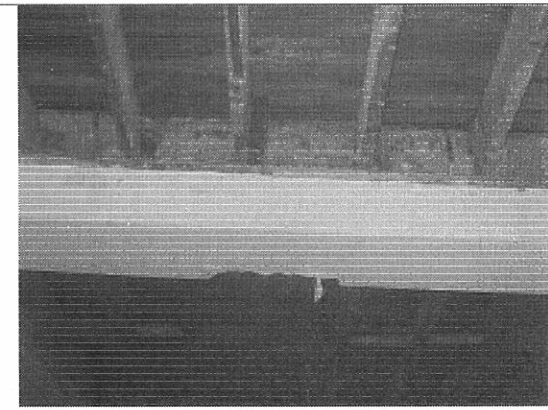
Deterioro en viga en concreto que soporta entrepiso del segundo nivel
